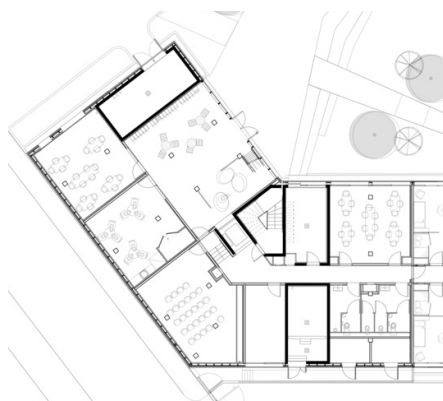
| Planta da zona Este da Moradia Estudantil em Marselha.
